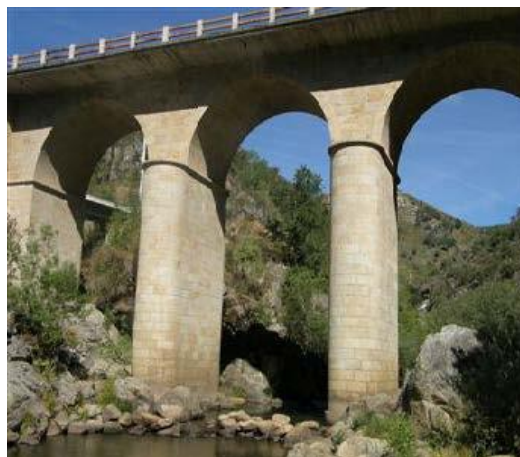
Pilares da ponte sobre o Rio Rabaçal (ponte nº 1)
